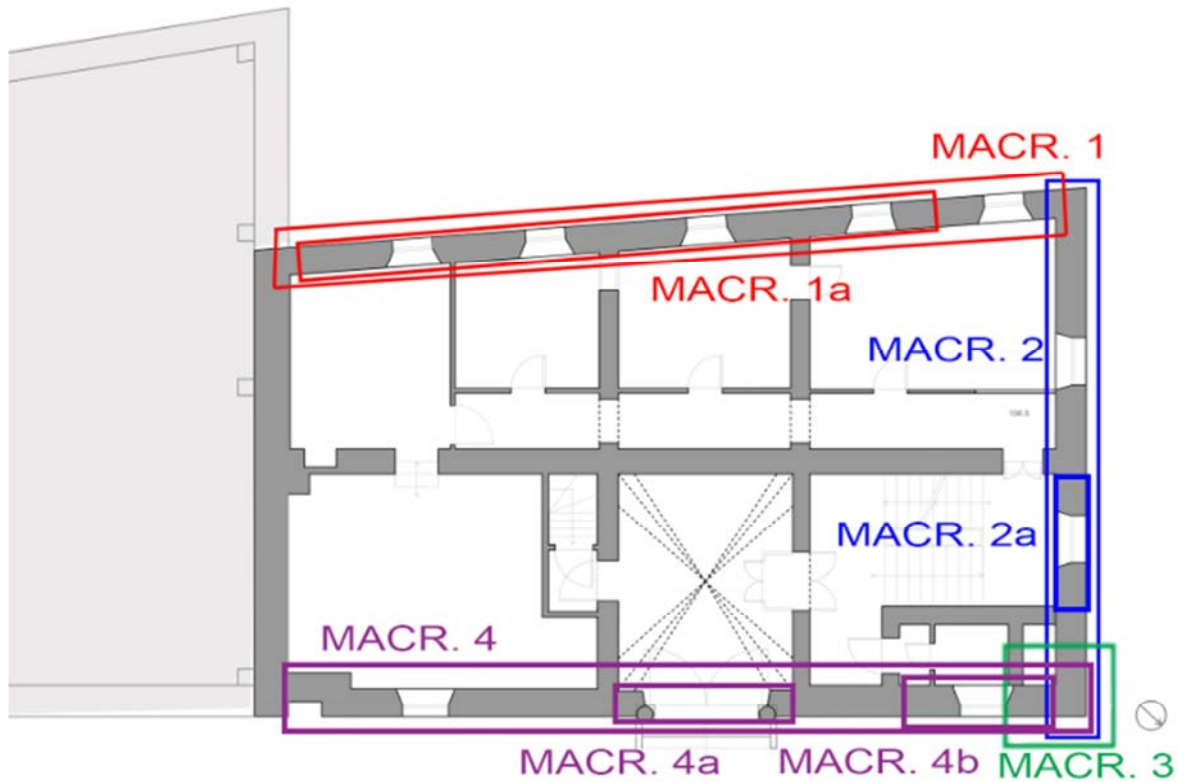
Individuazione in pianta dei macroelementi.
